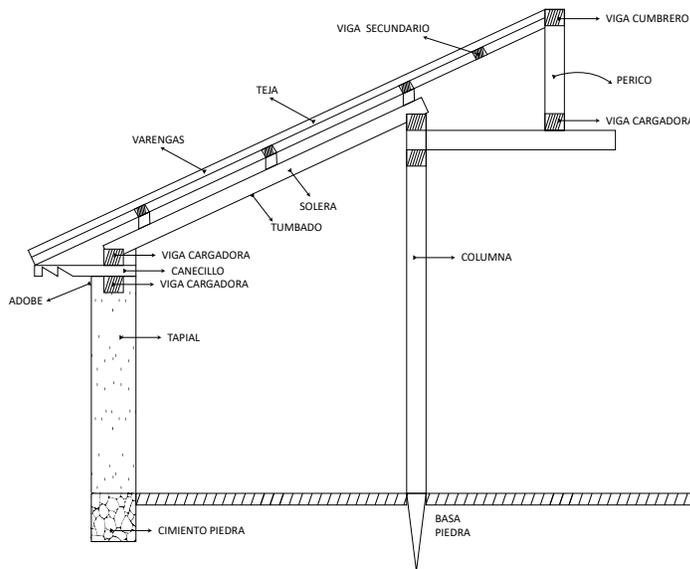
Corte de Sistema A porticado de Madera. (2024)
